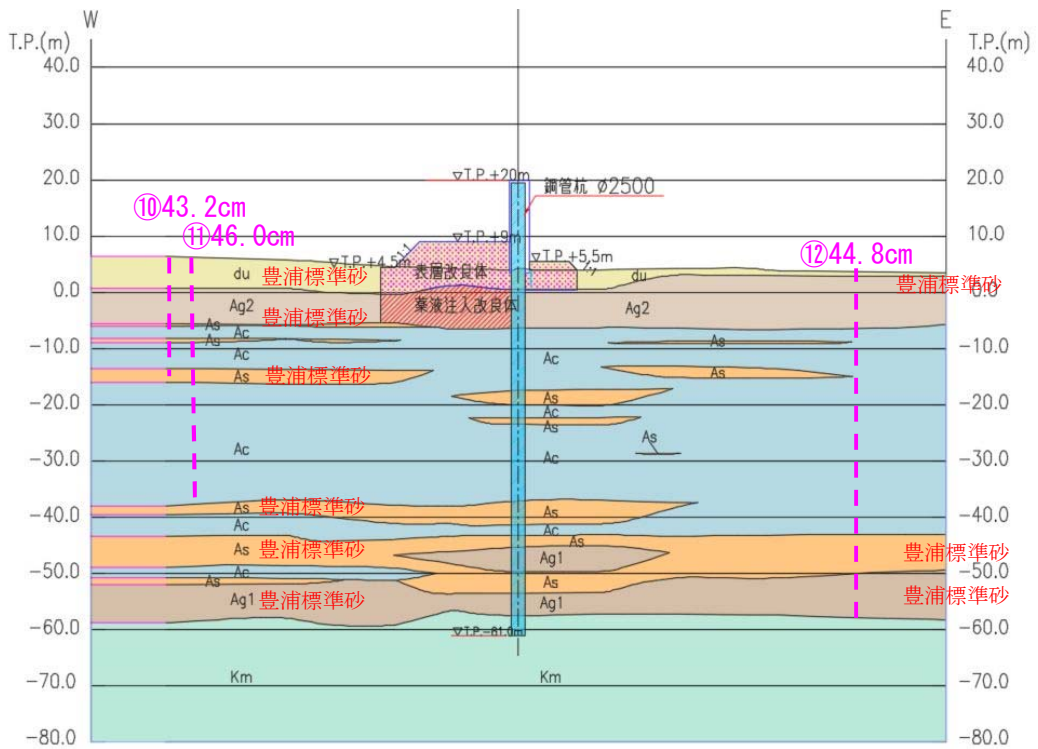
( 9 ) 鋼管杭鉄筋コンクリート防潮壁断面図 (二次元有効応力解析)
